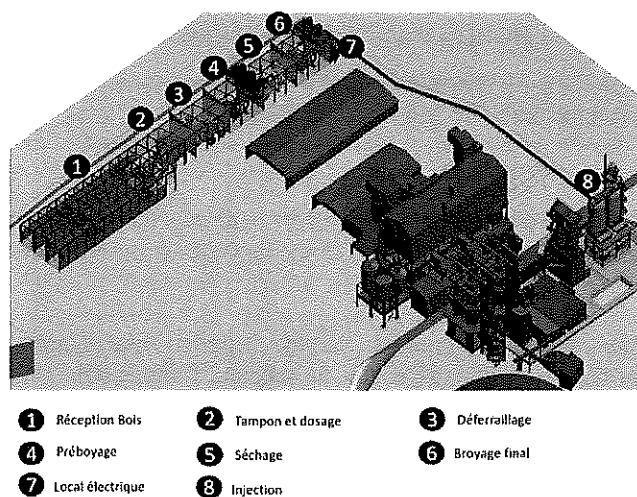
Vue d'ensemble du projet - issue de l'AENV
